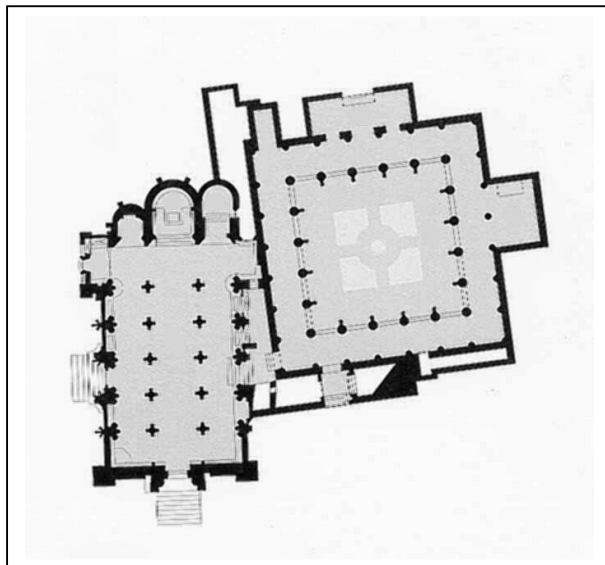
Planta da igreja e do claustro da Sé Velha de Coimbra
